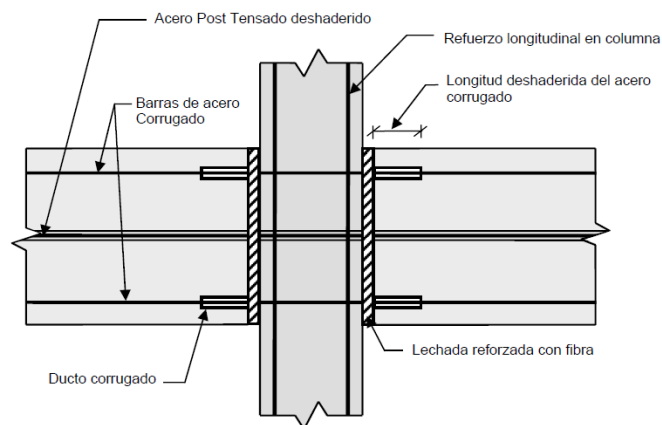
Detalles de la conexión híbrida del pórtico prefabricado
